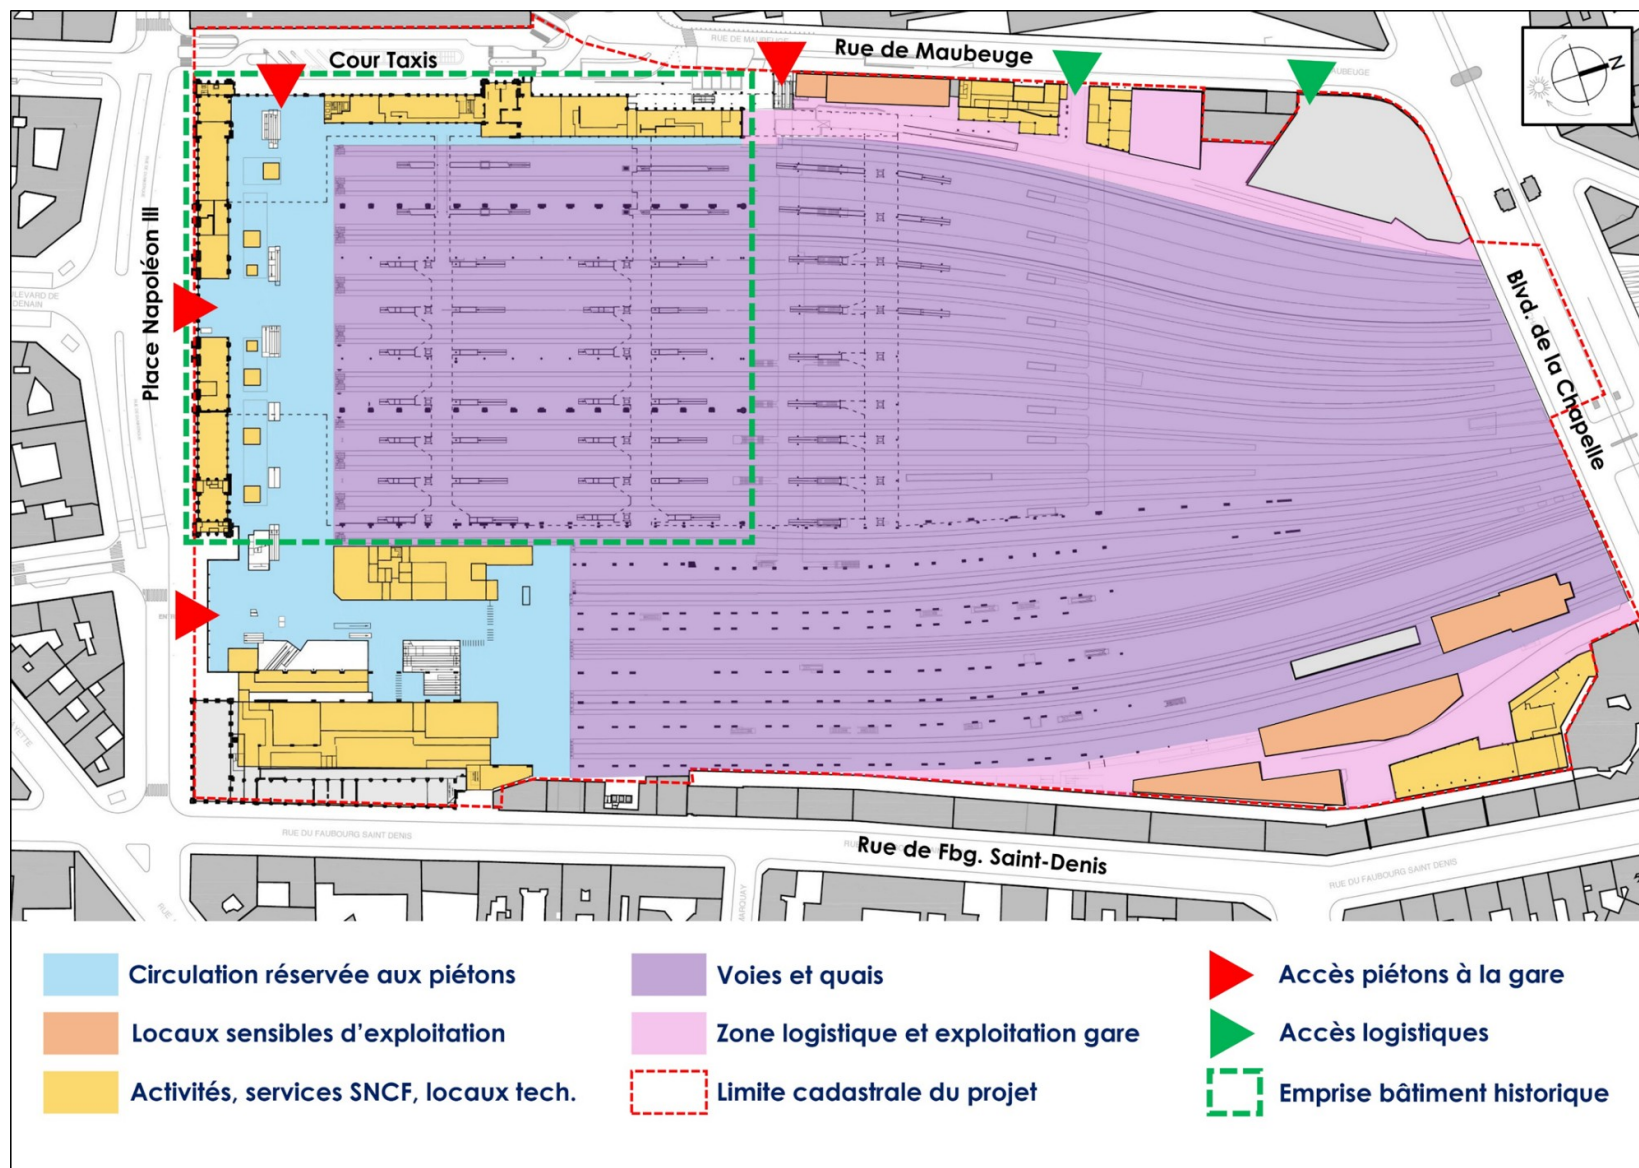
Plan du niveau N00 montrant l'occupation du site
